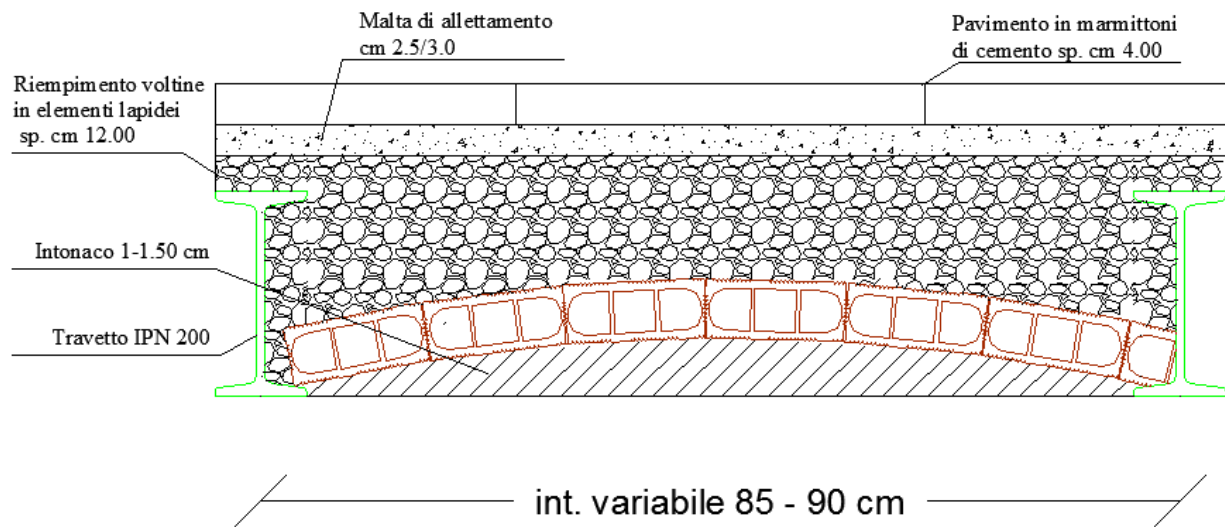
Sezione solaio tipo nella situazione ante - operam
